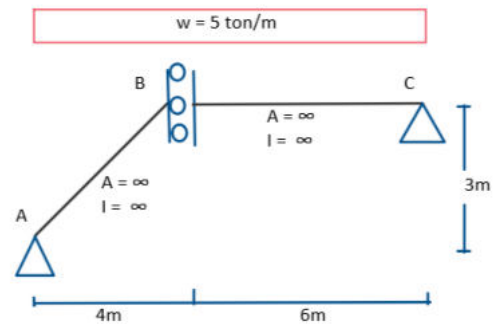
Idealización de sistema estructural con columnas inclinadas.
